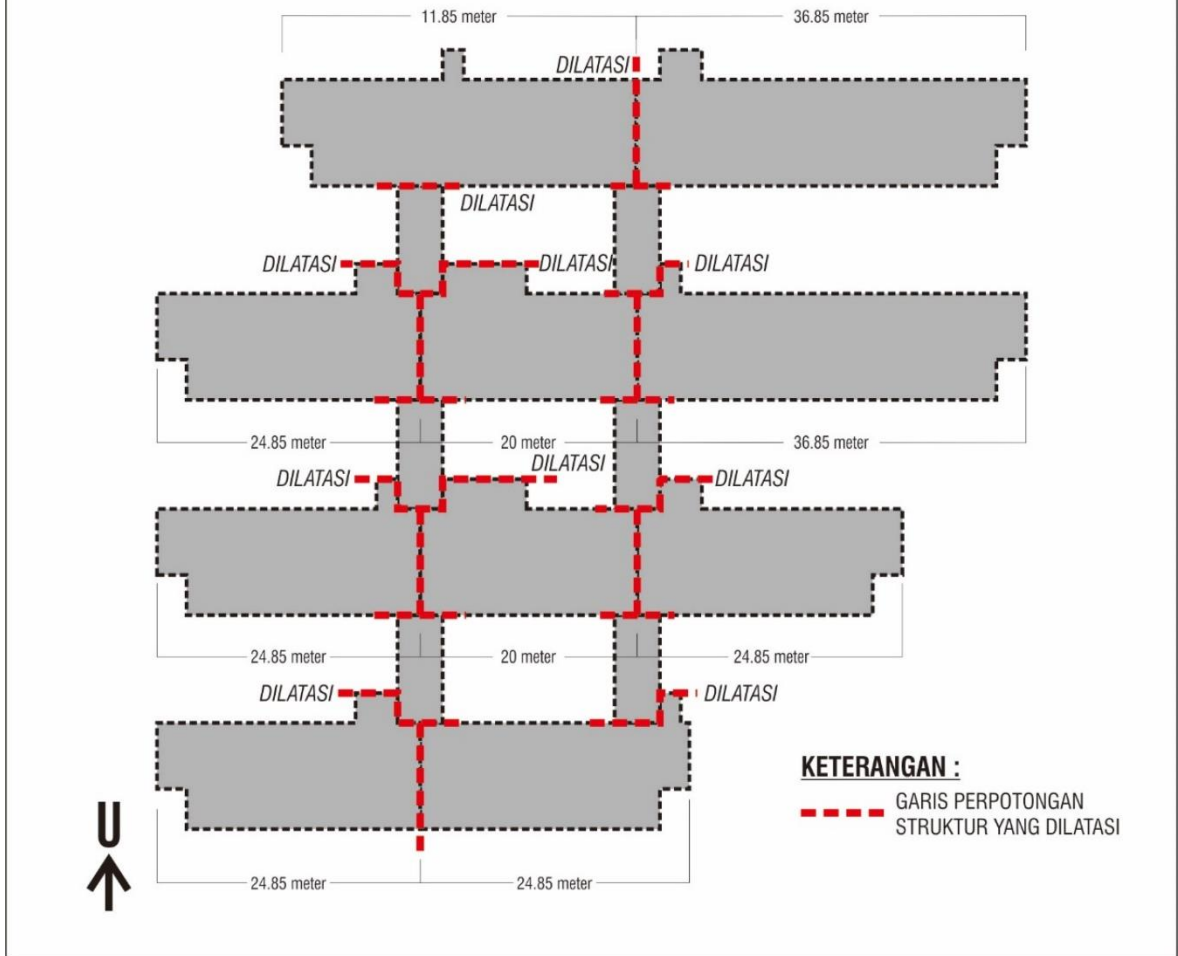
Rencana Pondasi Kampung Vertikal
